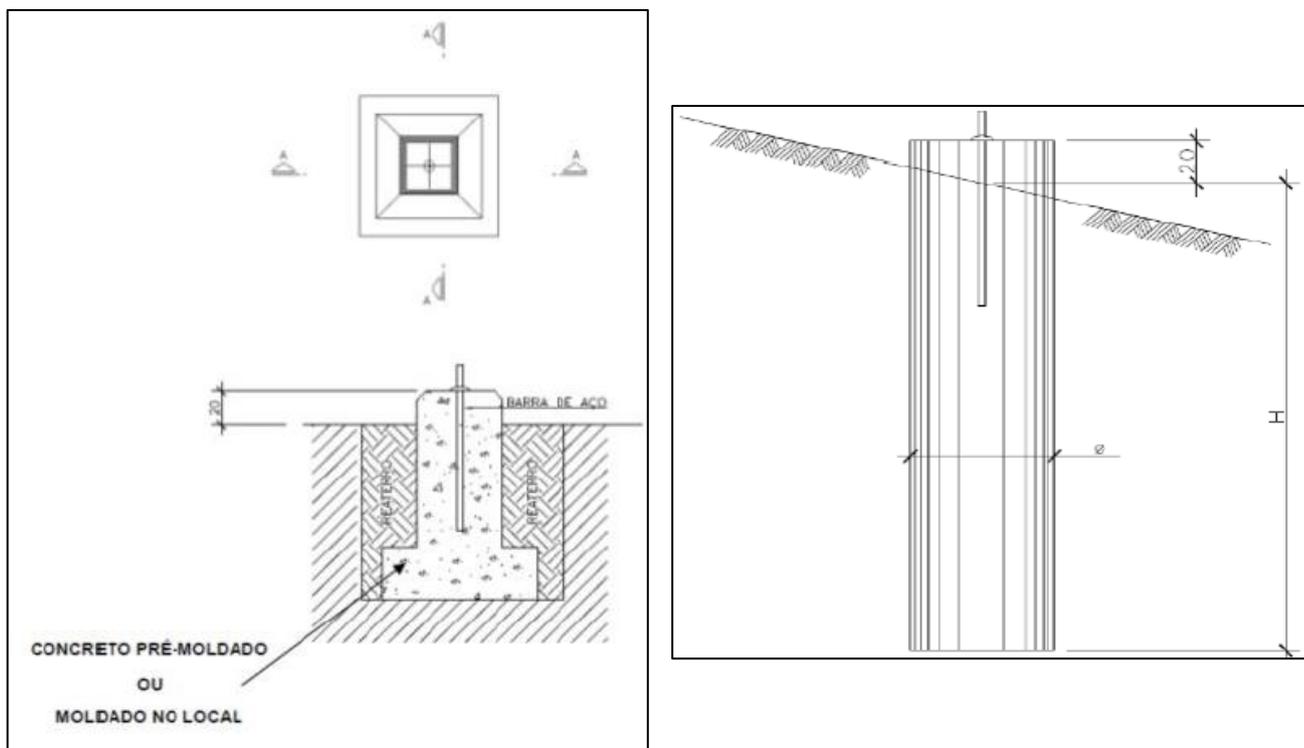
A esquerda fundação em sapata para mastro central e a direita Fundação em tubulão.
